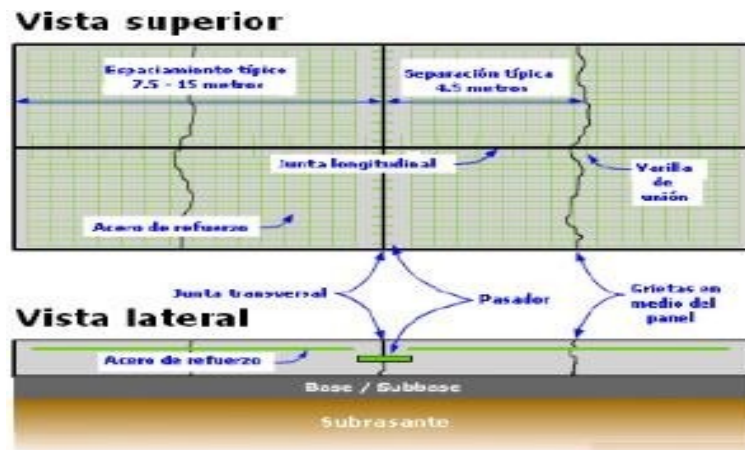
Losa de concreto reforzado. Fuente: Salgado, M. 2017.
